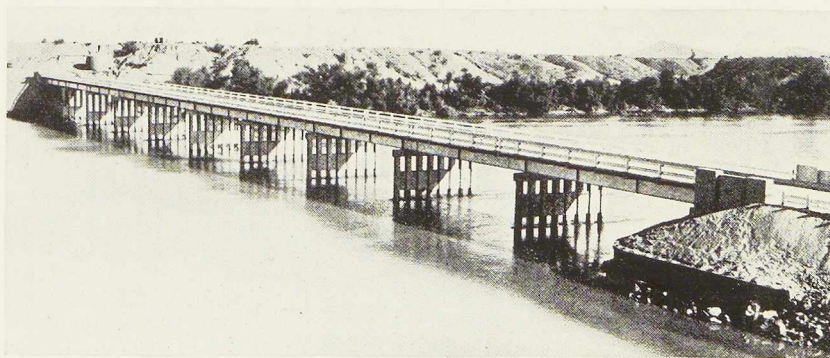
Pont sur le Colorado : les piles sont constituées chacune par 8 pieux en poutrelles métalliques à larges ailes.
